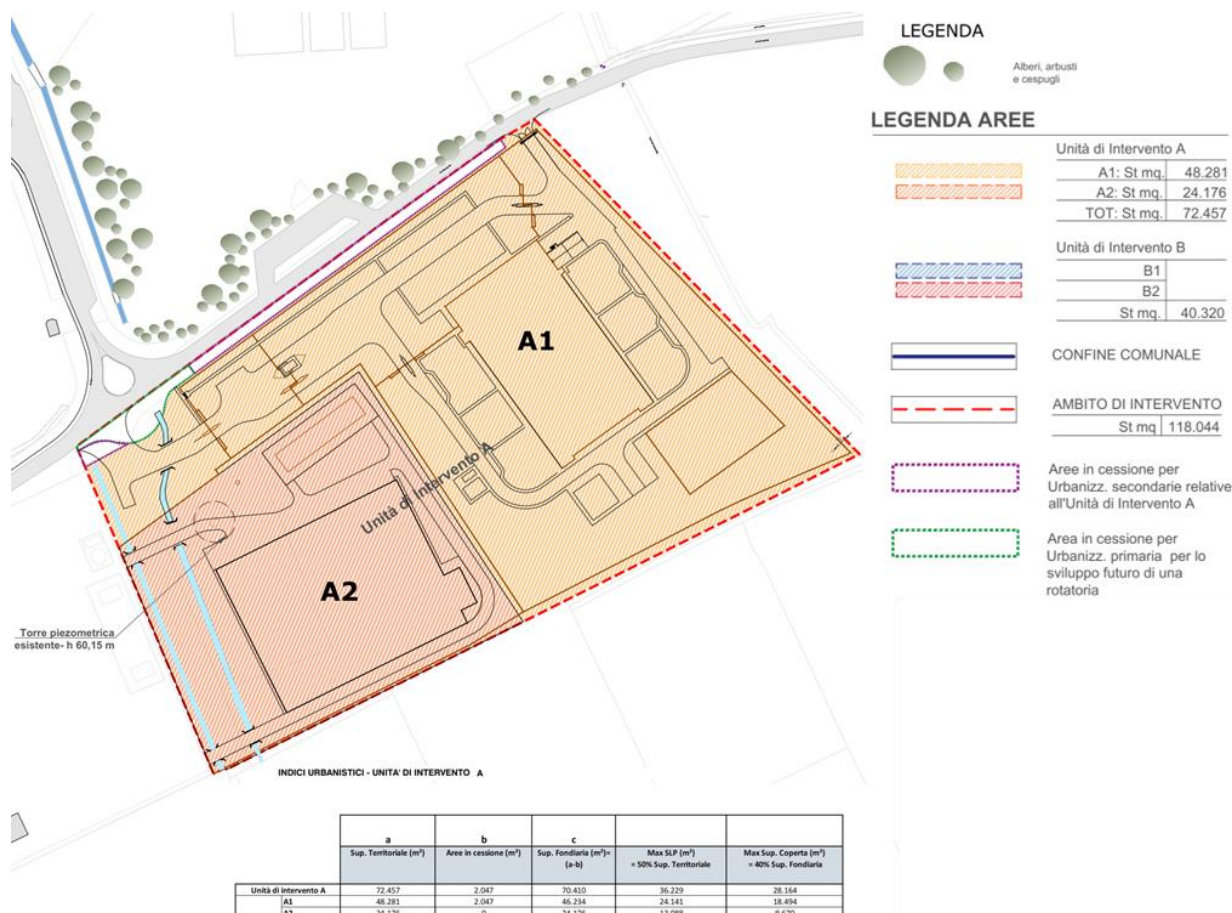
Estratto della Tavola T08 – “Planimetria generale con individuazione delle unità di intervento” del PUA.
